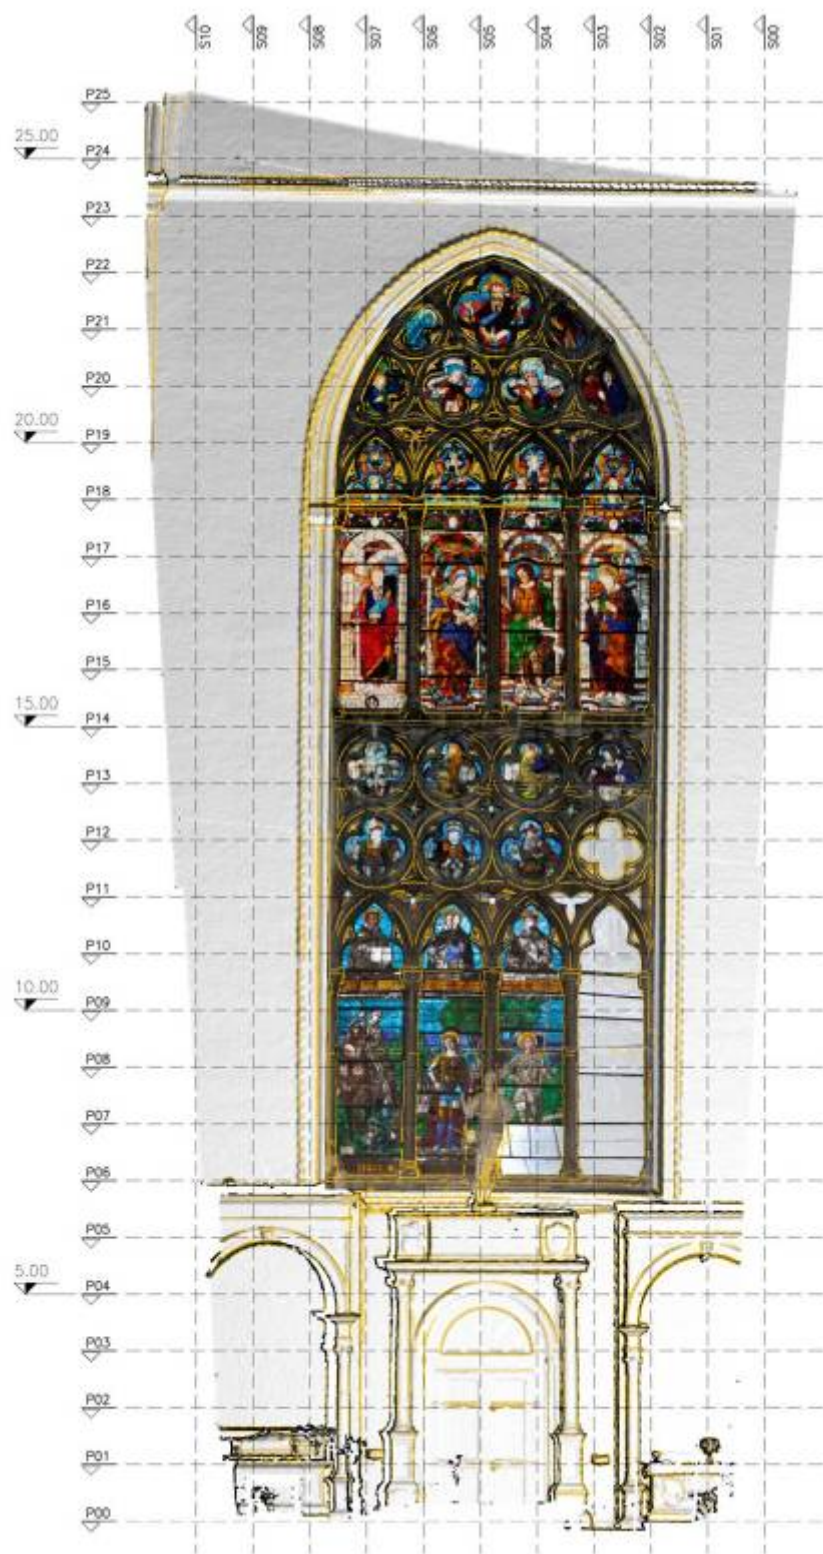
Prospetto interno con le linee di discontinuità e di sezione
